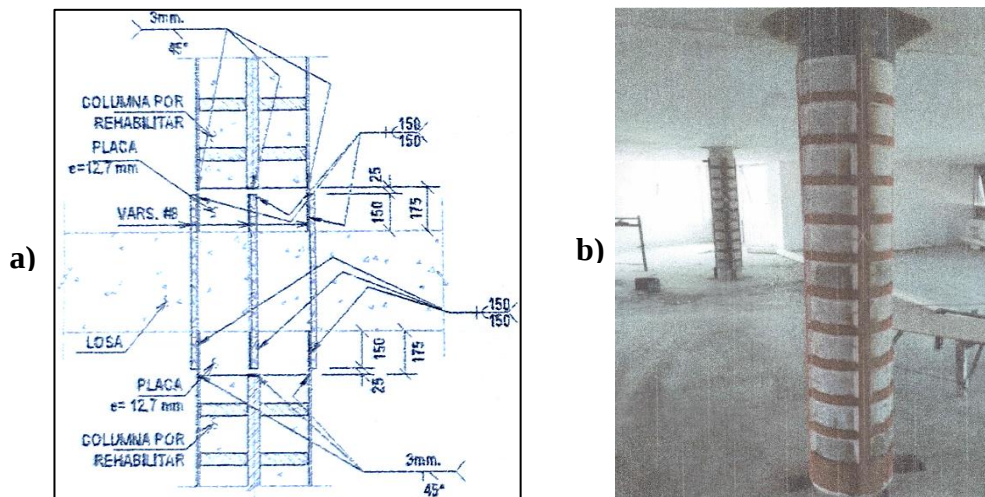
Encamisado con placas y soleras en columnas circulares: a) detalles del sistema de refuerzo del Conjunto Aristos y b) configuración del encamisado. Gómez González (2020).
